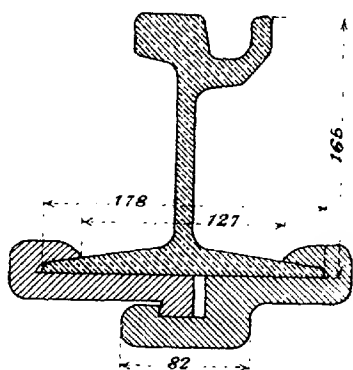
Querschnitt a—b bei Keilbefestigung.
